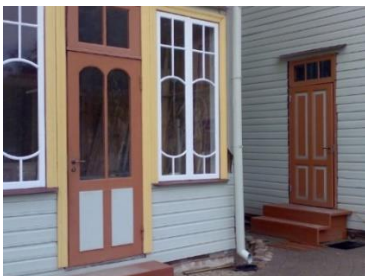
Restaureeritud majanduskoja välisuks ning betoontrepi asemele rajatud puittrepp (2011)
